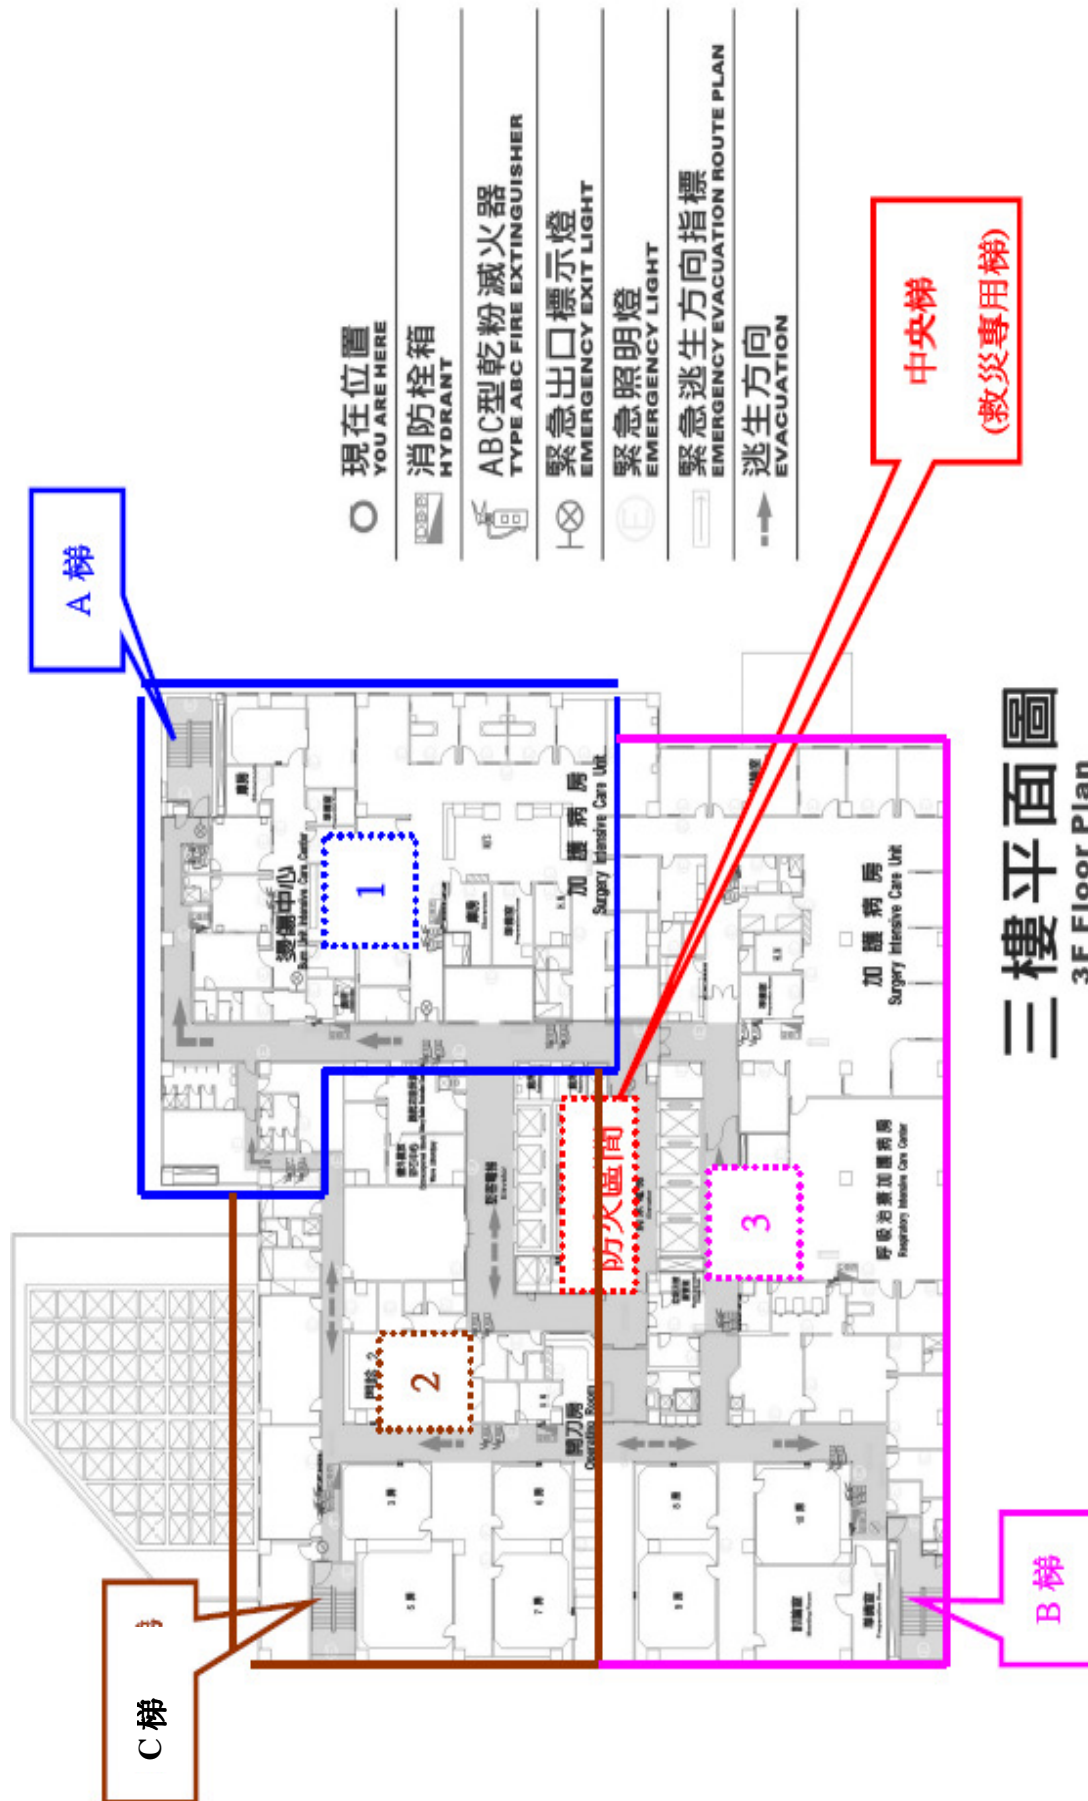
平面圖 B-某醫院大樓 3 樓平面圖
